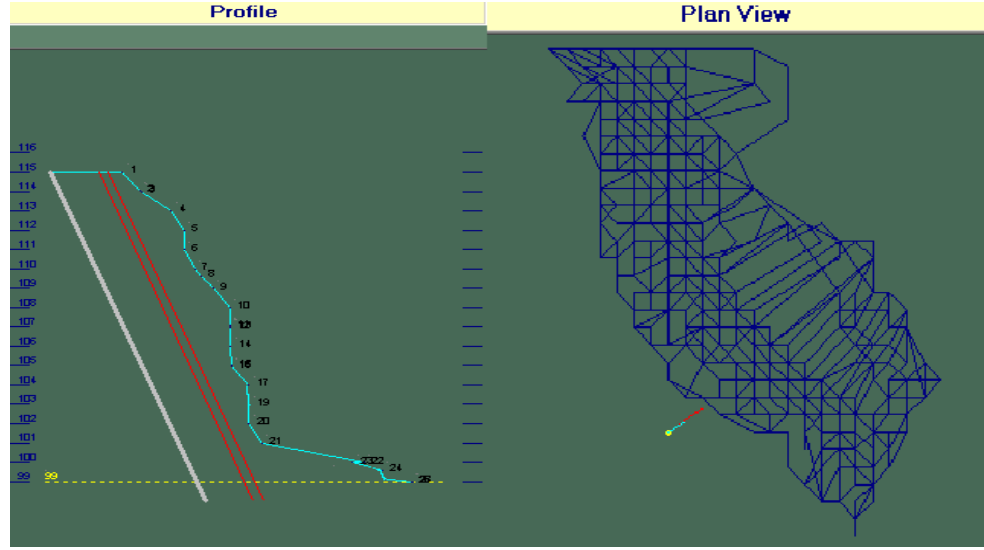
Ömerli sahası delik profili ve plan görünümü (aynanın sol kısmı 3. delik)
